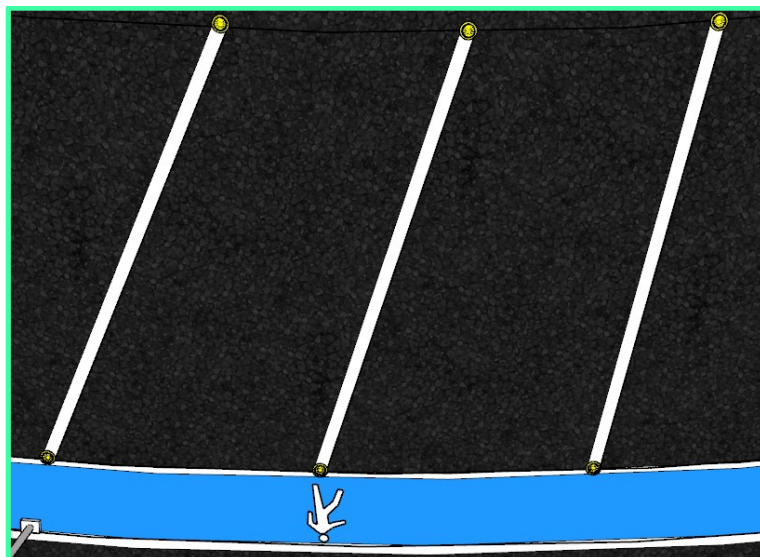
Diseño de plazas orientadas a la pantalla de proyección. Fuente: Elaboración propia
